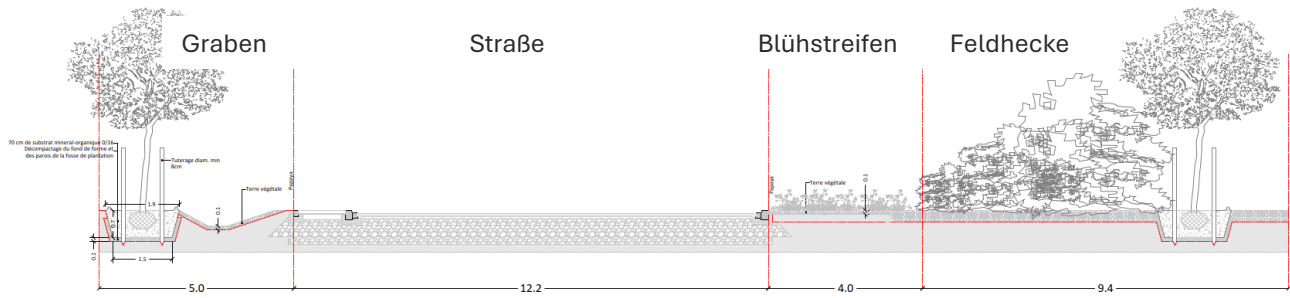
Detail E-E des Plan de Plantation, südöstliche Eingrünung (Quelle: Papaya Sàrl 2025). Größere Darstellung in Anhang 06a.
